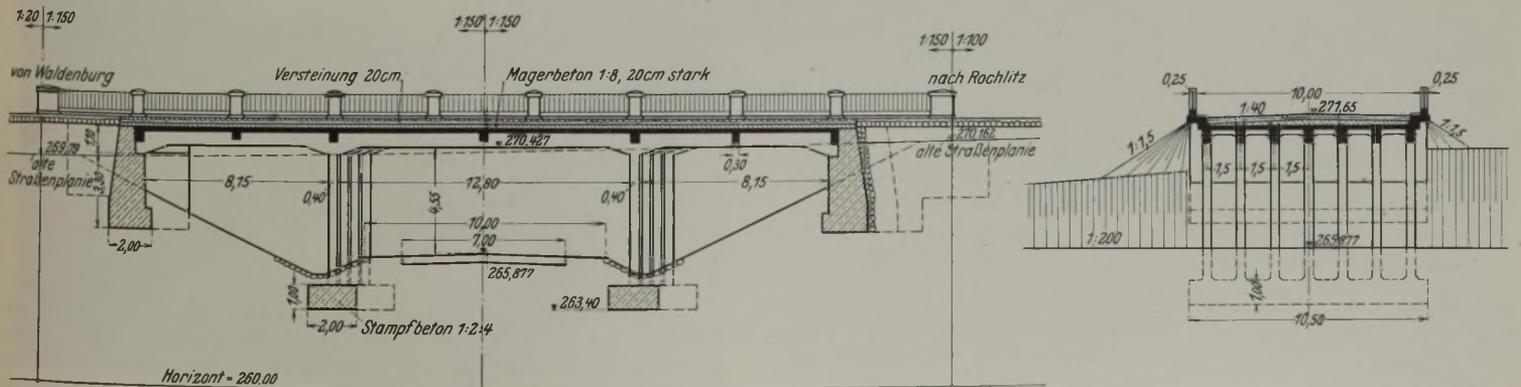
Kreuzungsbauwerk der beiden Staatsstraßen.
